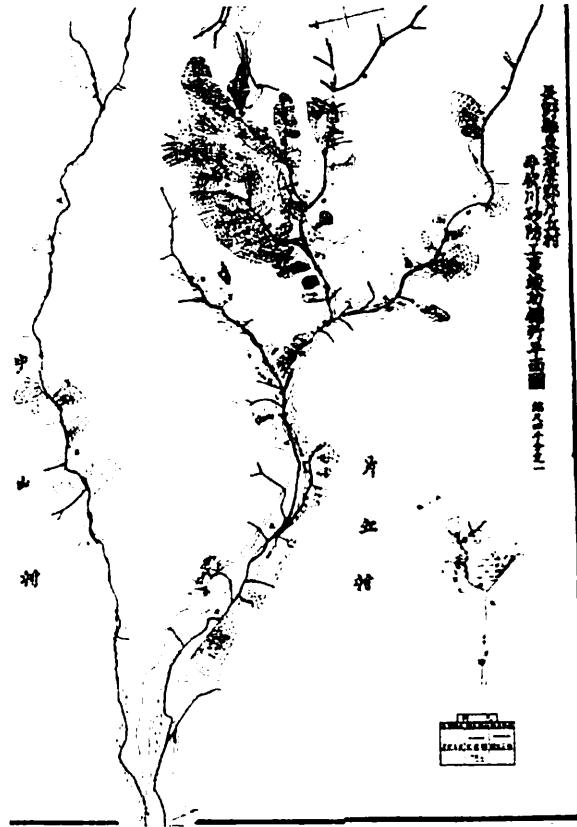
大正7年牛伏川砂防工事箇所竣工平面図
